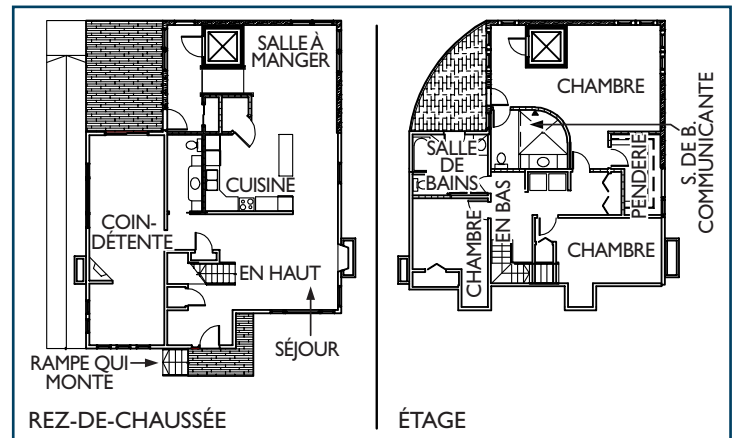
Plans du rez-de-chaussée et de l'étage de la maison rendue accessible une fois les travaux réalisés
